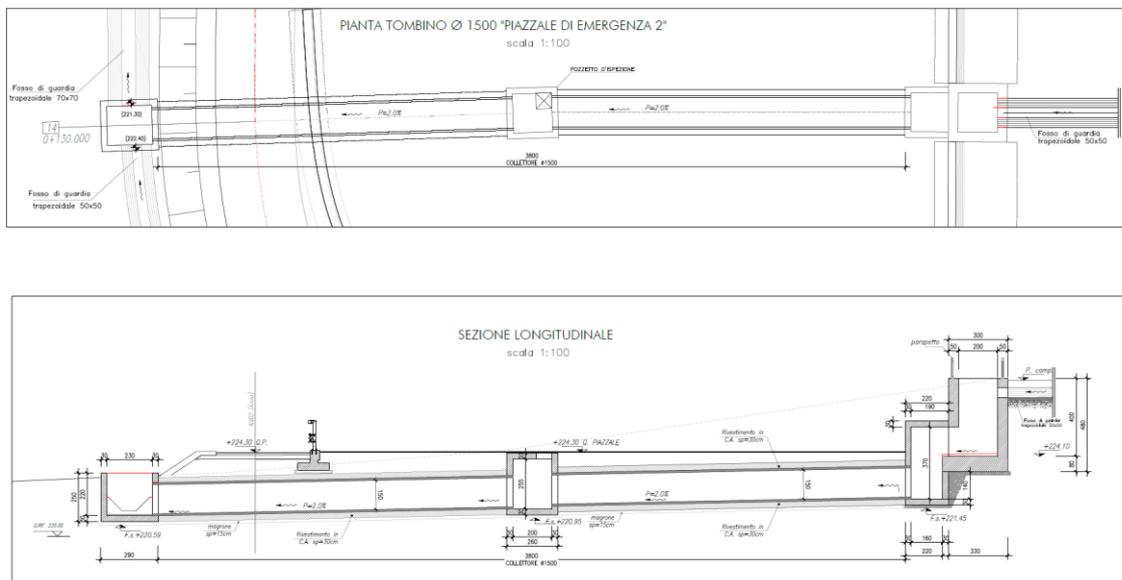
Inquadramento planimetrico e sezione longitudinale
